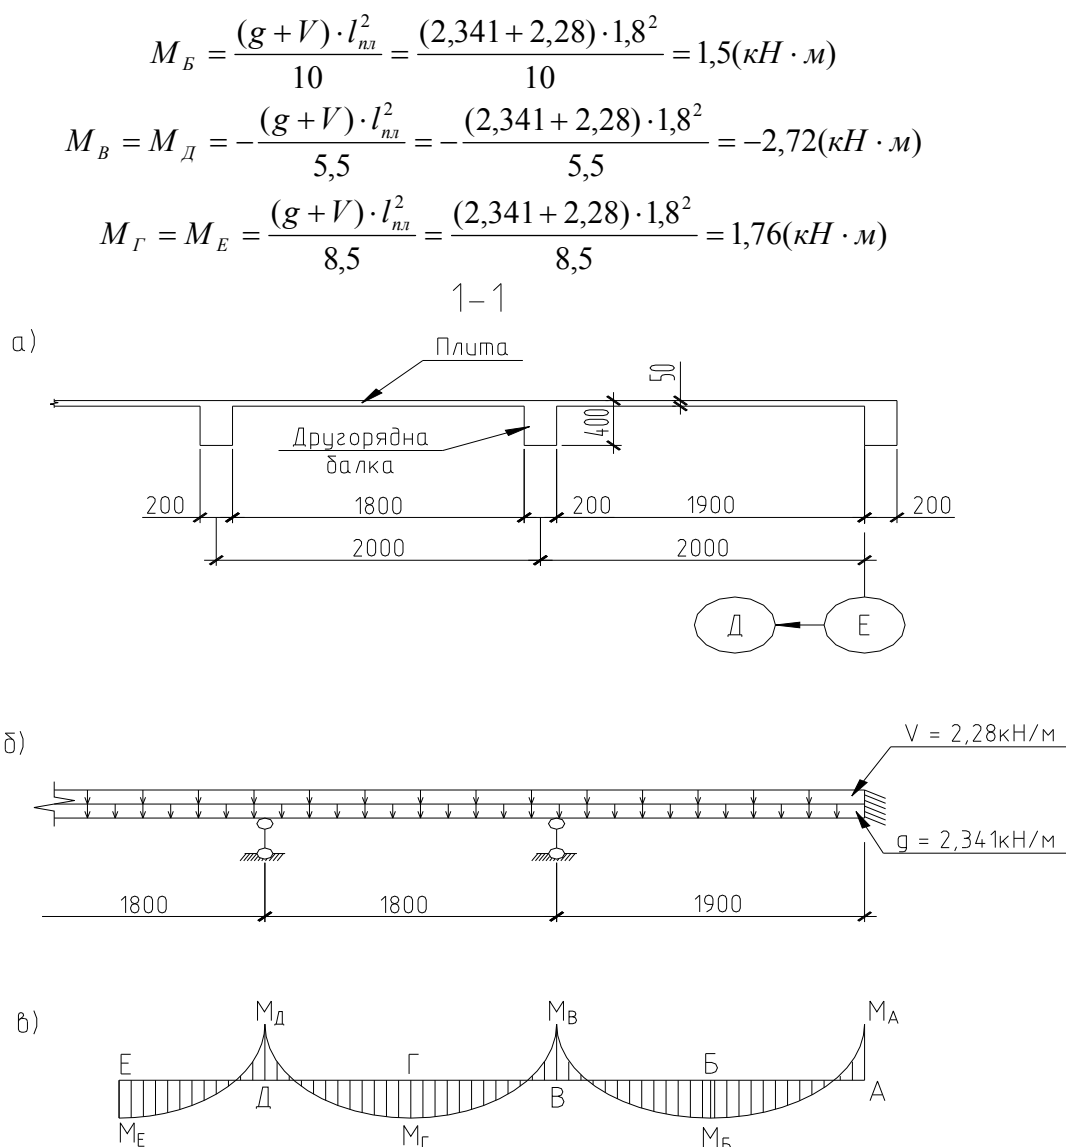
Балочна плита: а) – конструктивна схема; б) – розрахункова схема; в) – епюра згинаючих моментів
